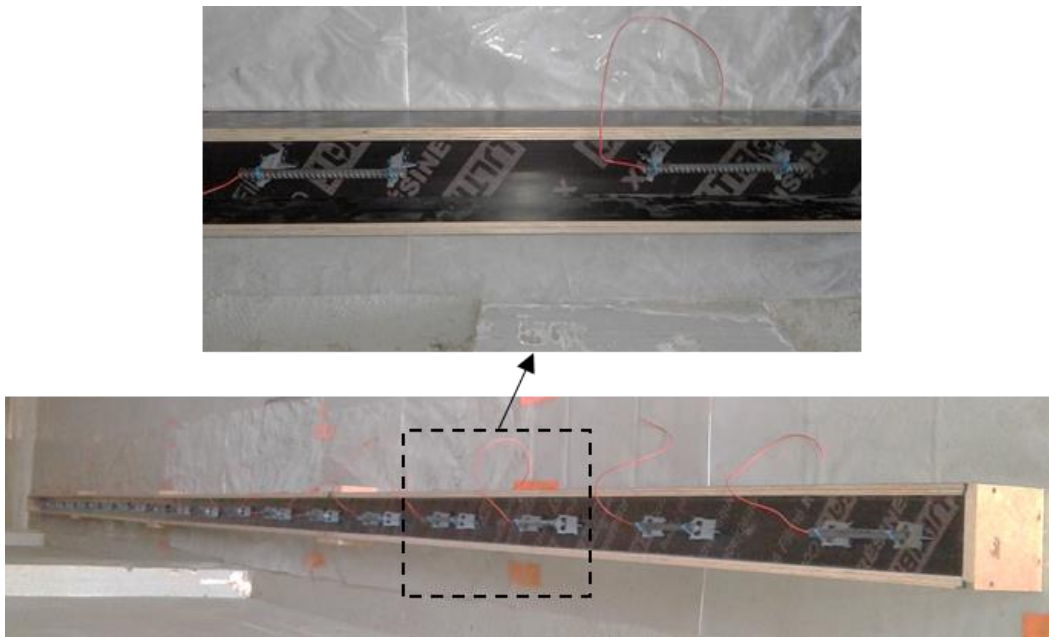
Moule et Ferrailage de la Poutre  $P_{C1}$
